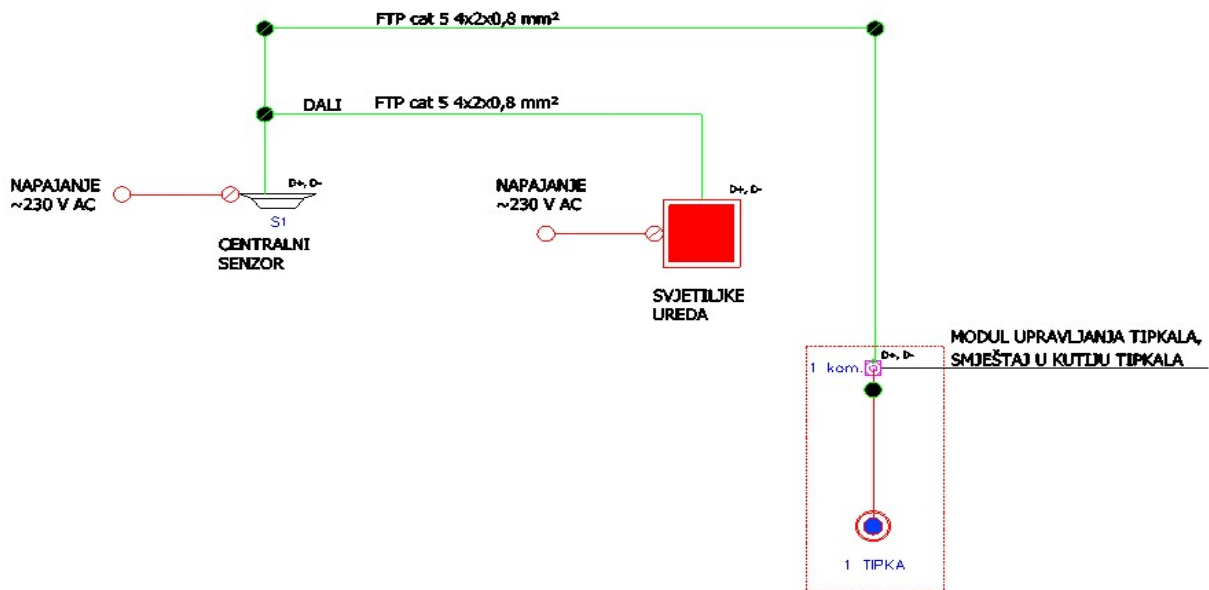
Blok shema upravljanja rasvjetom preko senzora pokreta.
